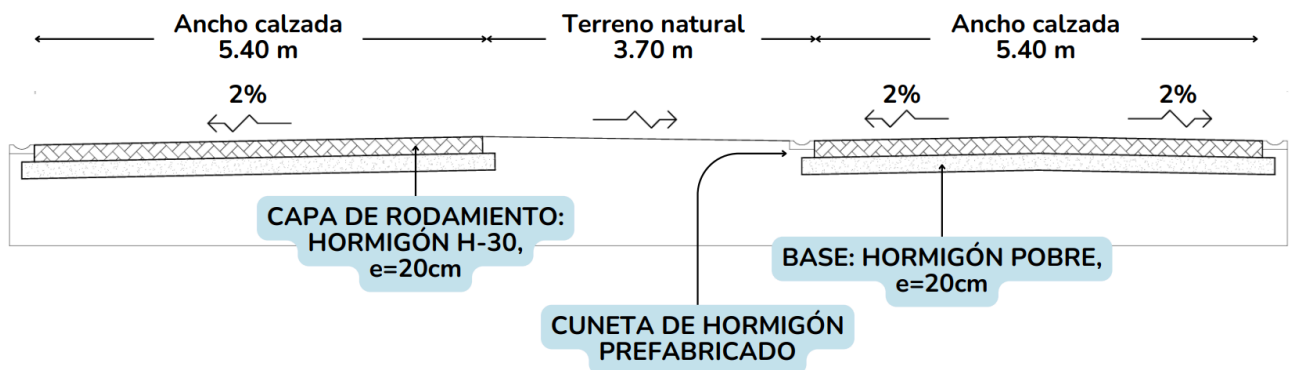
Perfil tipo correspondiente al ingreso a la terminal. Fuente: Elaboración propia.
